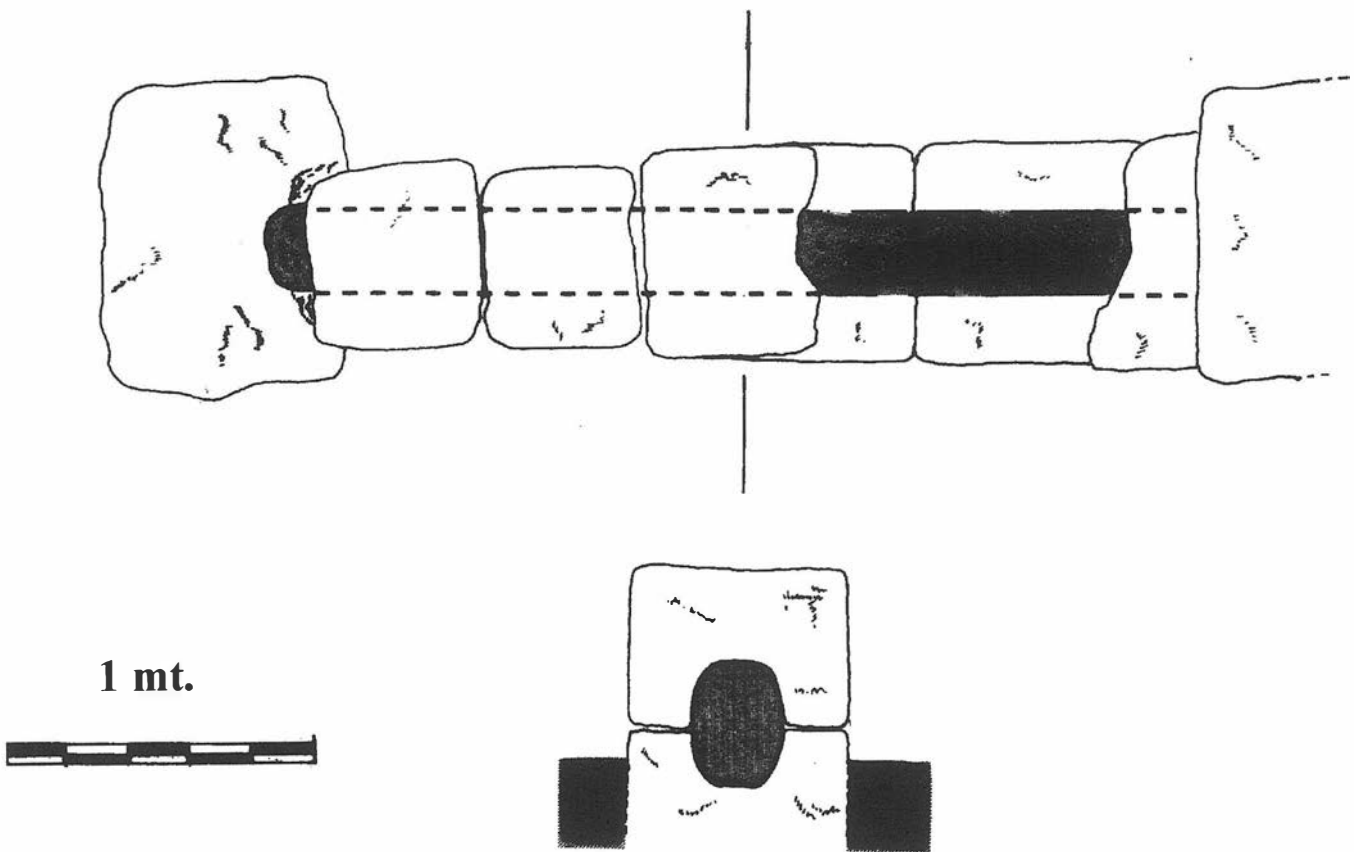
Planta y secciones atarjea UE-13, altoimperial.
